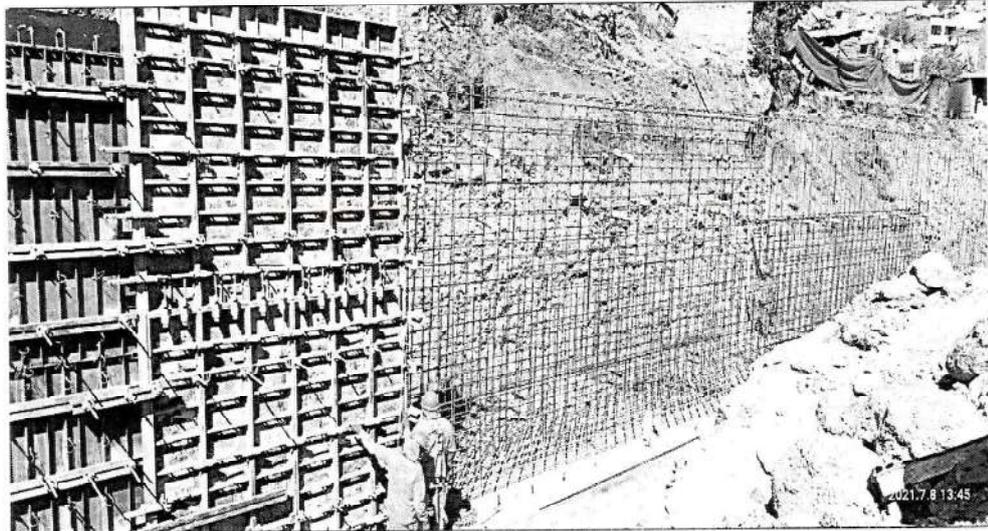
Se aprecia colocado de aceros transversales y longitudinales en el intradós y trasdós de la pantalla del muro de contención tipo I.
